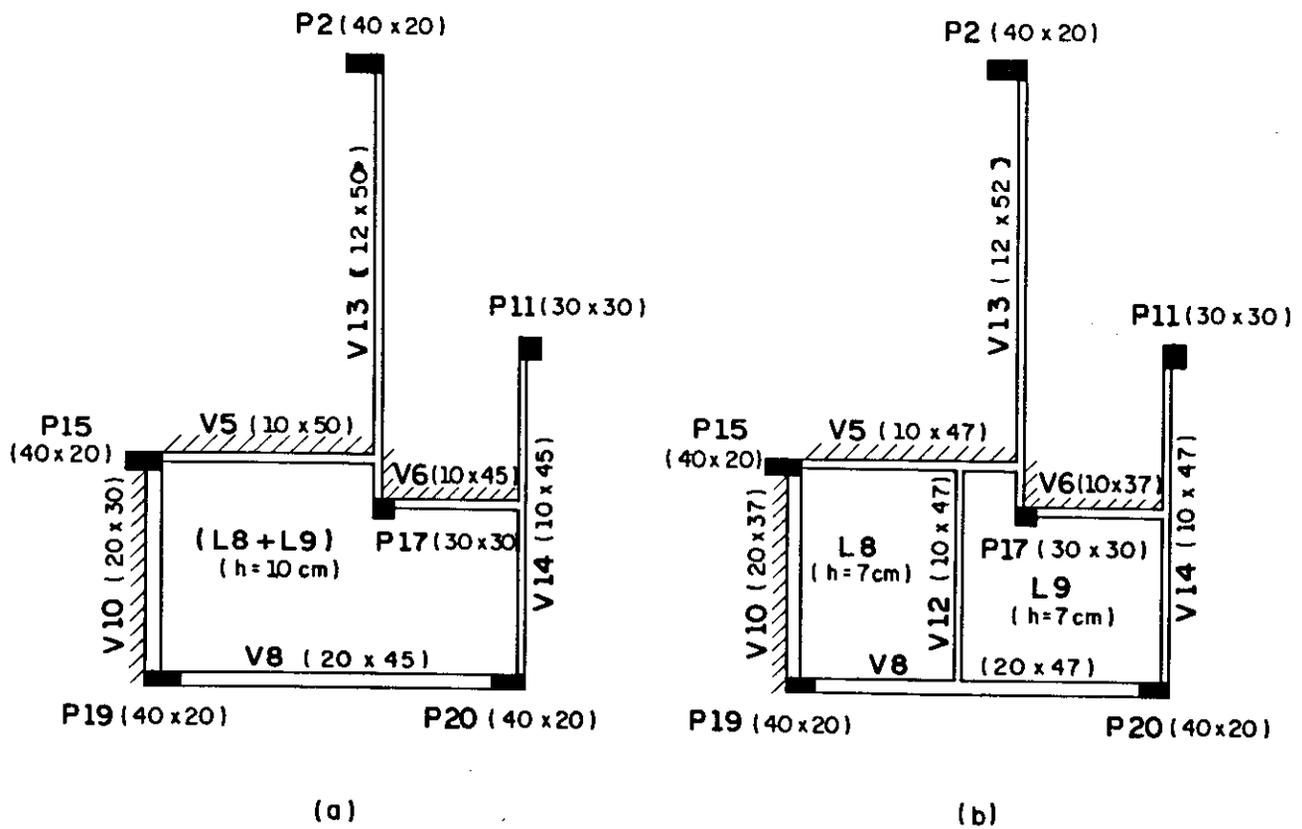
Painéis para o Estudo da Viabilidade da Adoção das Vigas V12 da ESTRUTURA II
